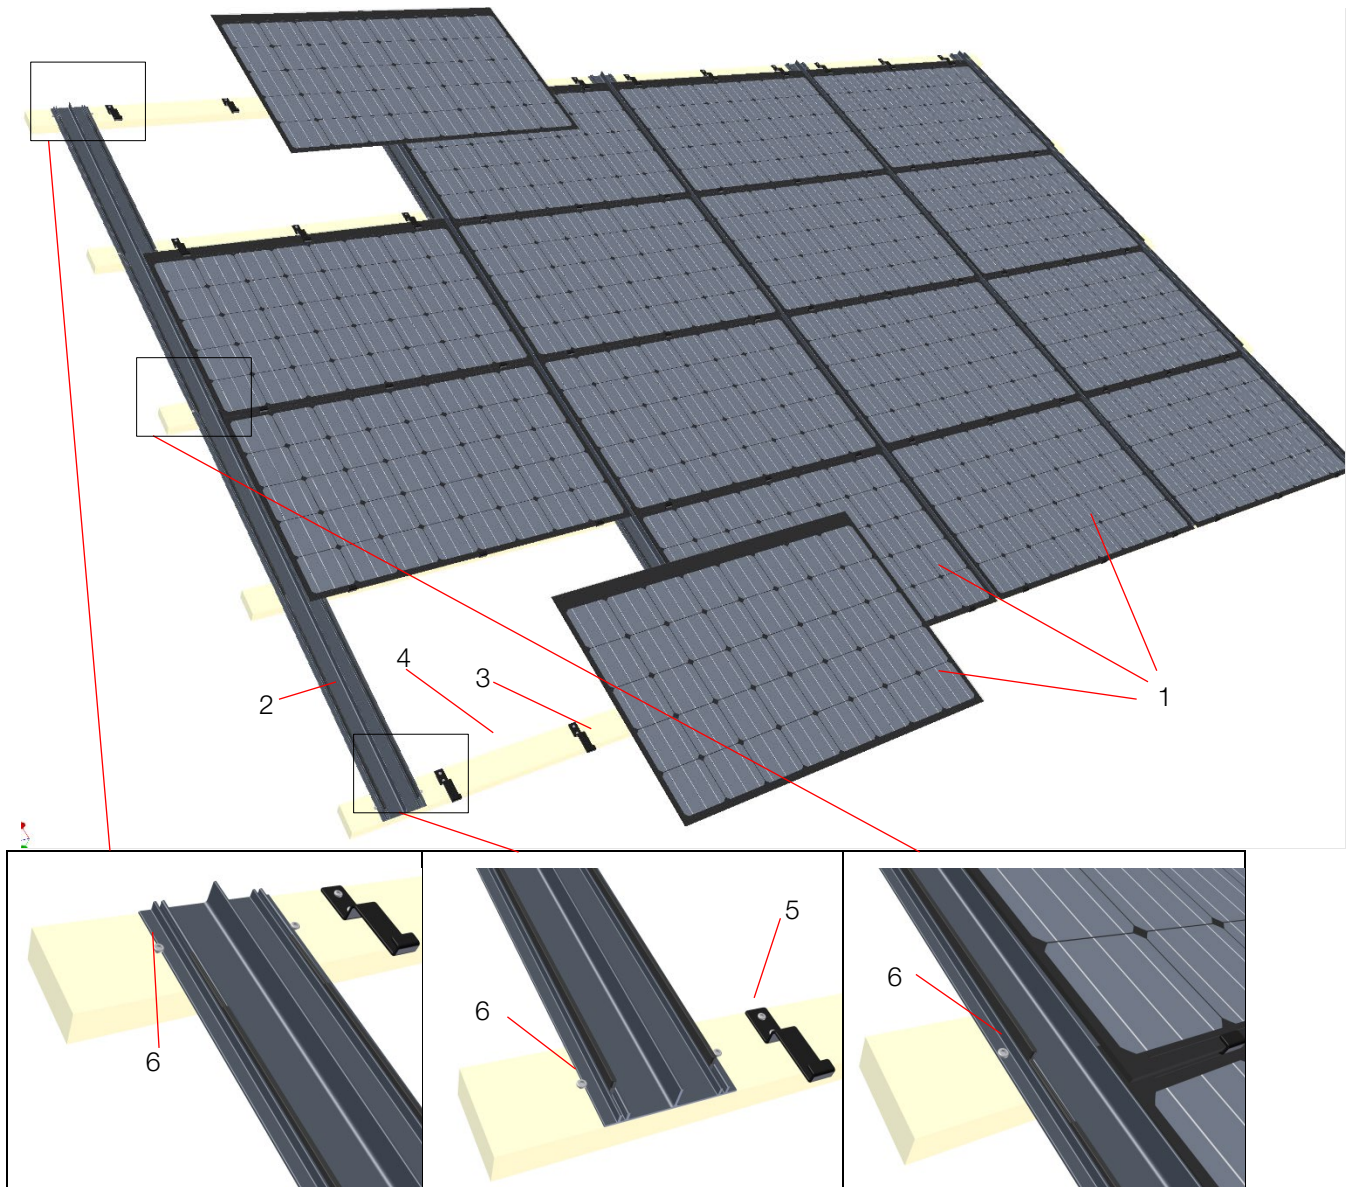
Zeichnung TeraSlate Dachausschnitt
